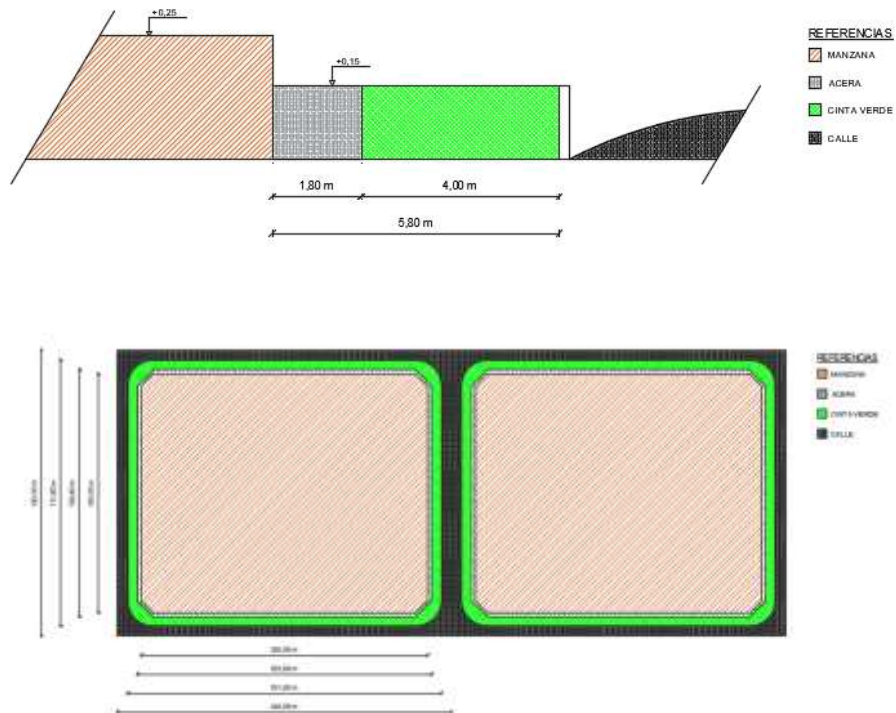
Distribución de superficies en lote, manzana, vereda y calle.
